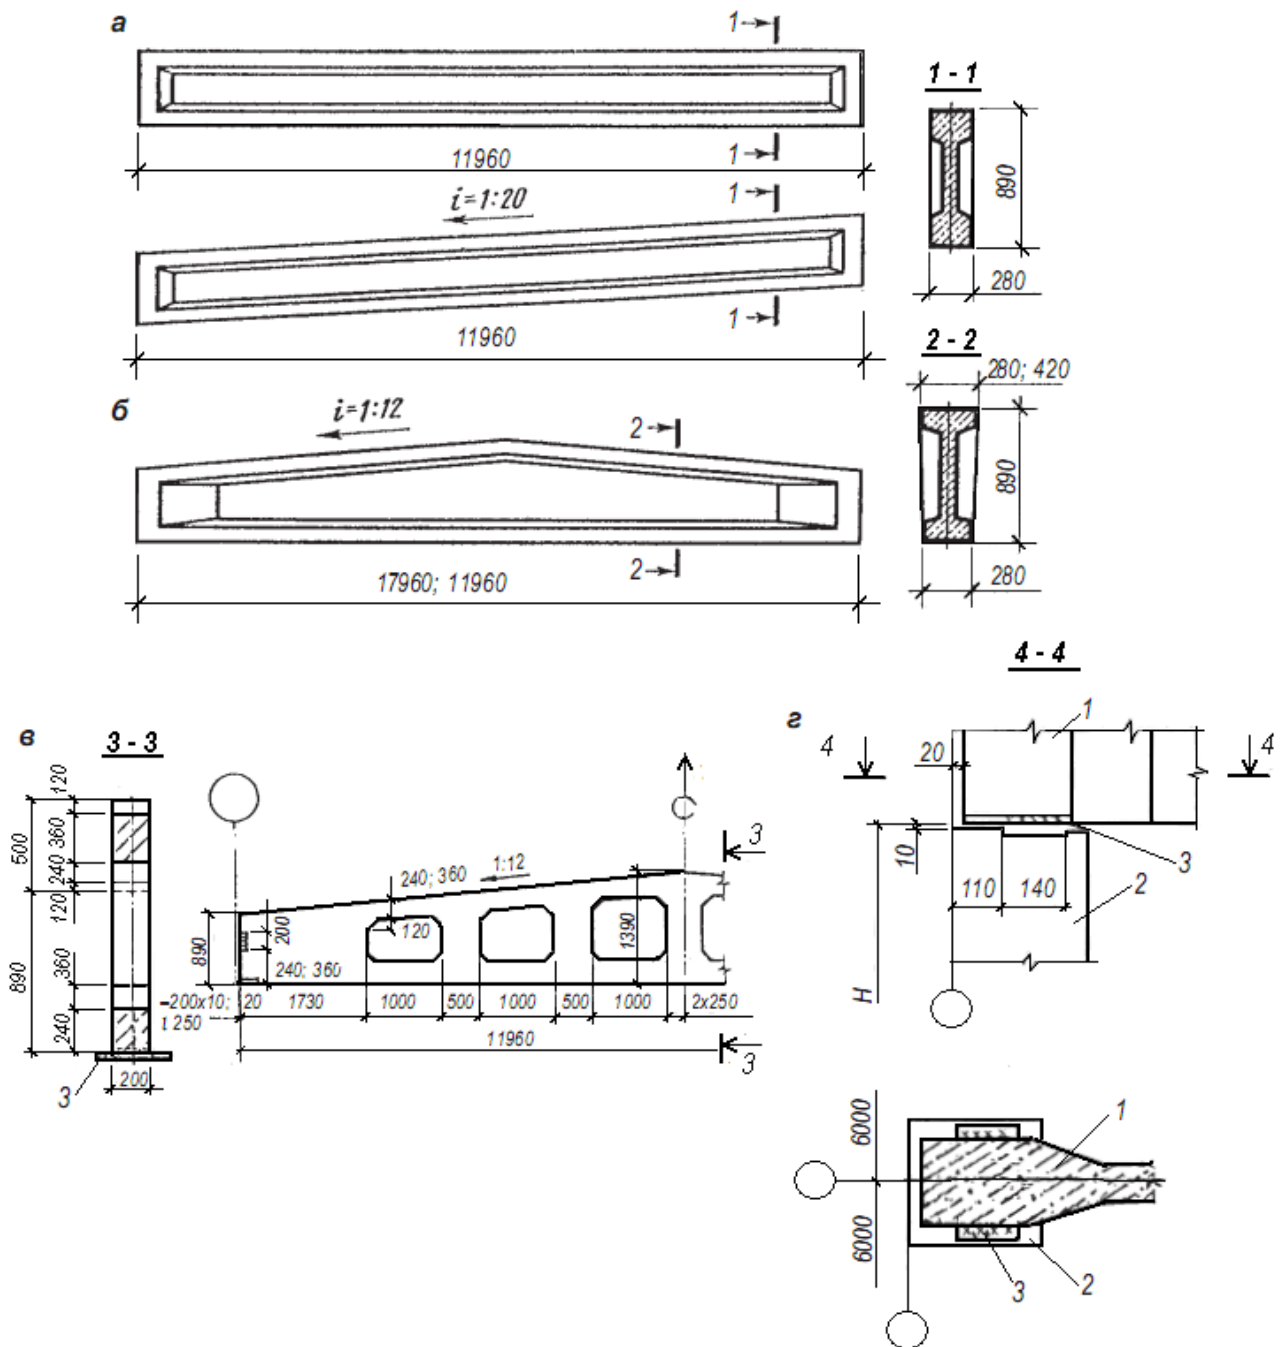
Залізобетонні кроквяні балки покриття: а – односкілі двотаврового перерізу; б – двоскілі для багатосхилих покриттів; в – решітчасті; г – вузол оперття балки на колону; 1 – балка; 2 – колона; 3 – опорний лист
